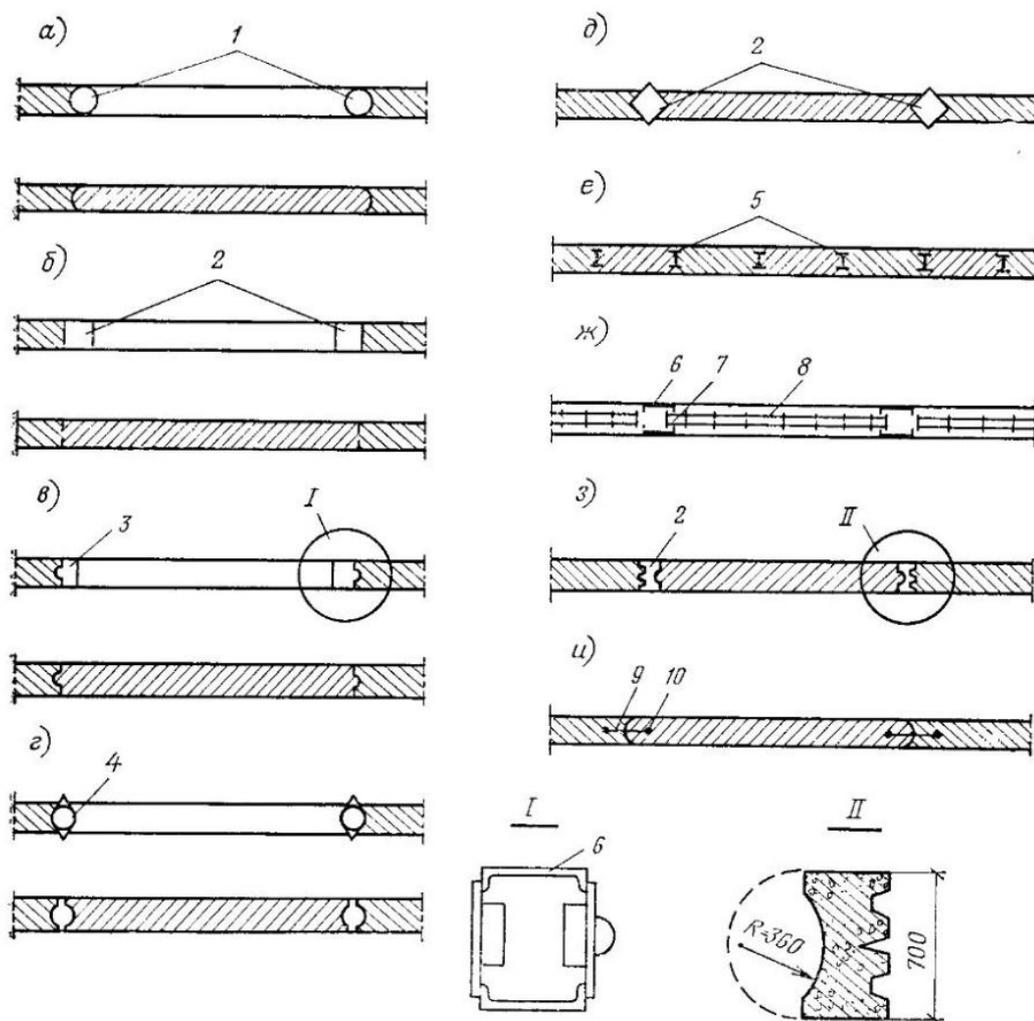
Виды ограничителей: 1-трубы; 2-железобетонные балки; 3-стальные балки; 4-трубы с уголками; 5-двутавры; 6-швеллеры; 7-фланец; 8-арматурный каркас; 9-полоса из полихлорвинила; 10-стальные строжни
